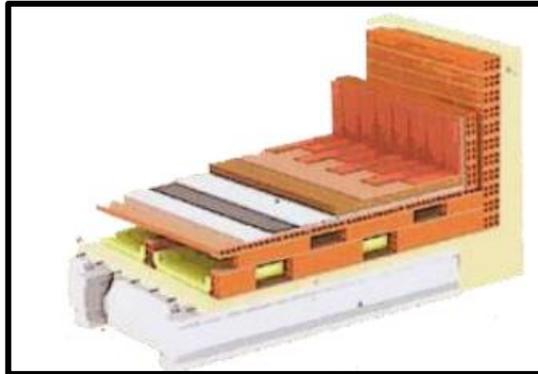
Cubierta plana ventilada, transitable, tradicional.
